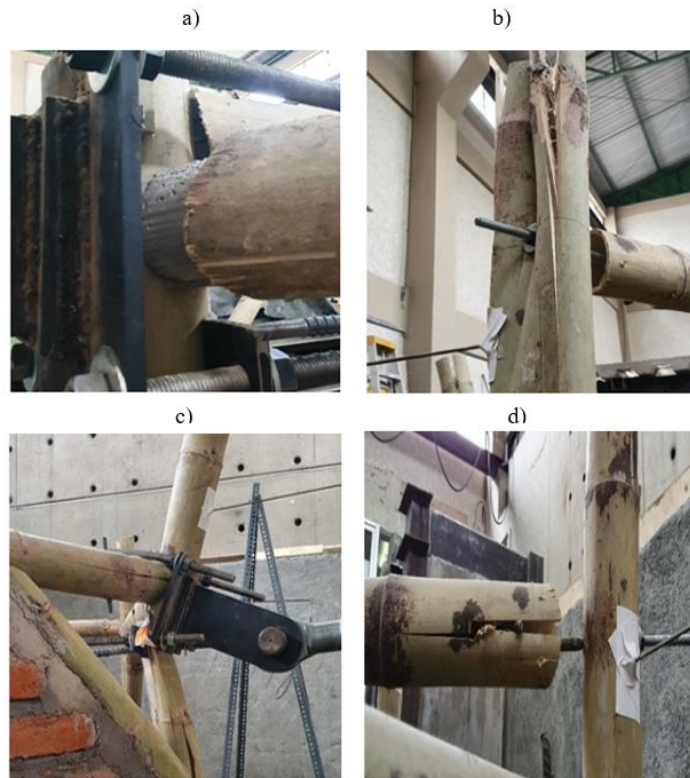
Fallas obtenidas en estructura espacial hexagonal de caña *G. angustifolia* durante el ensayo a carga lateral. a) Deslizamiento de viga, b) Falla por aplastamiento en columna, c) Falla por aplastamiento en columna, d) Falla a corte en viga.
